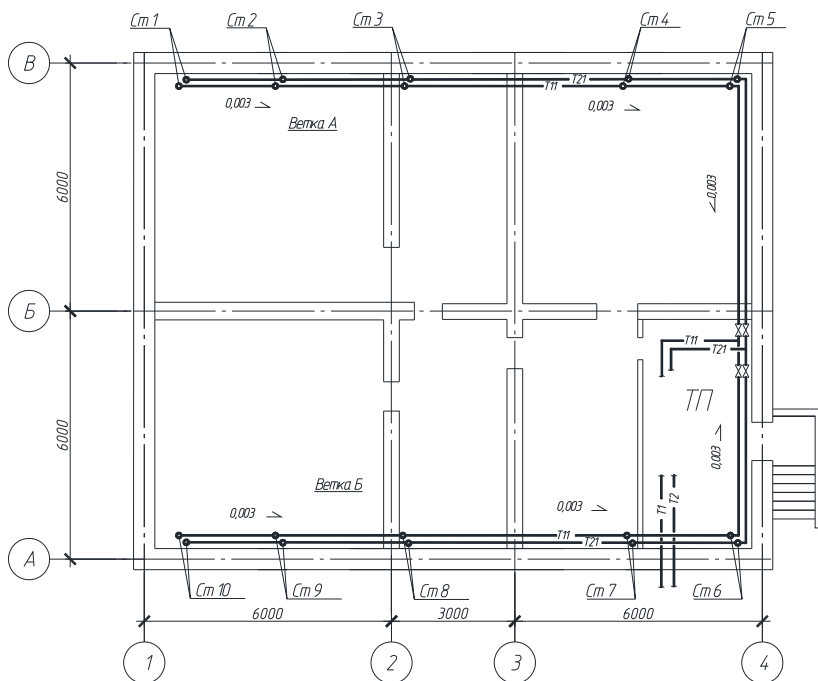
План подвала с нижней разводкой трубопроводов
